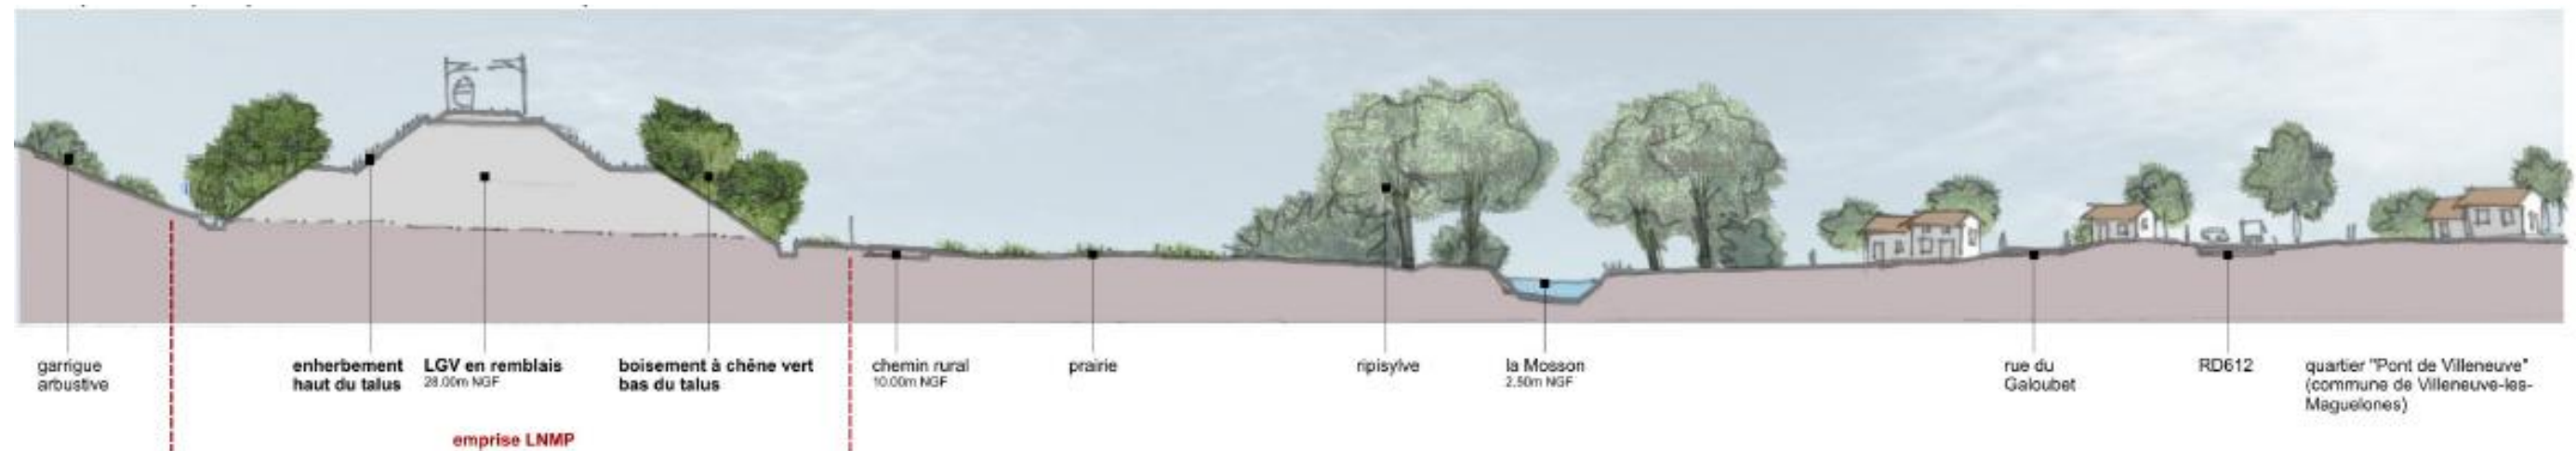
profil en travers au droit du pont de Villeneuve sur la Mosson (source : Traverses)
